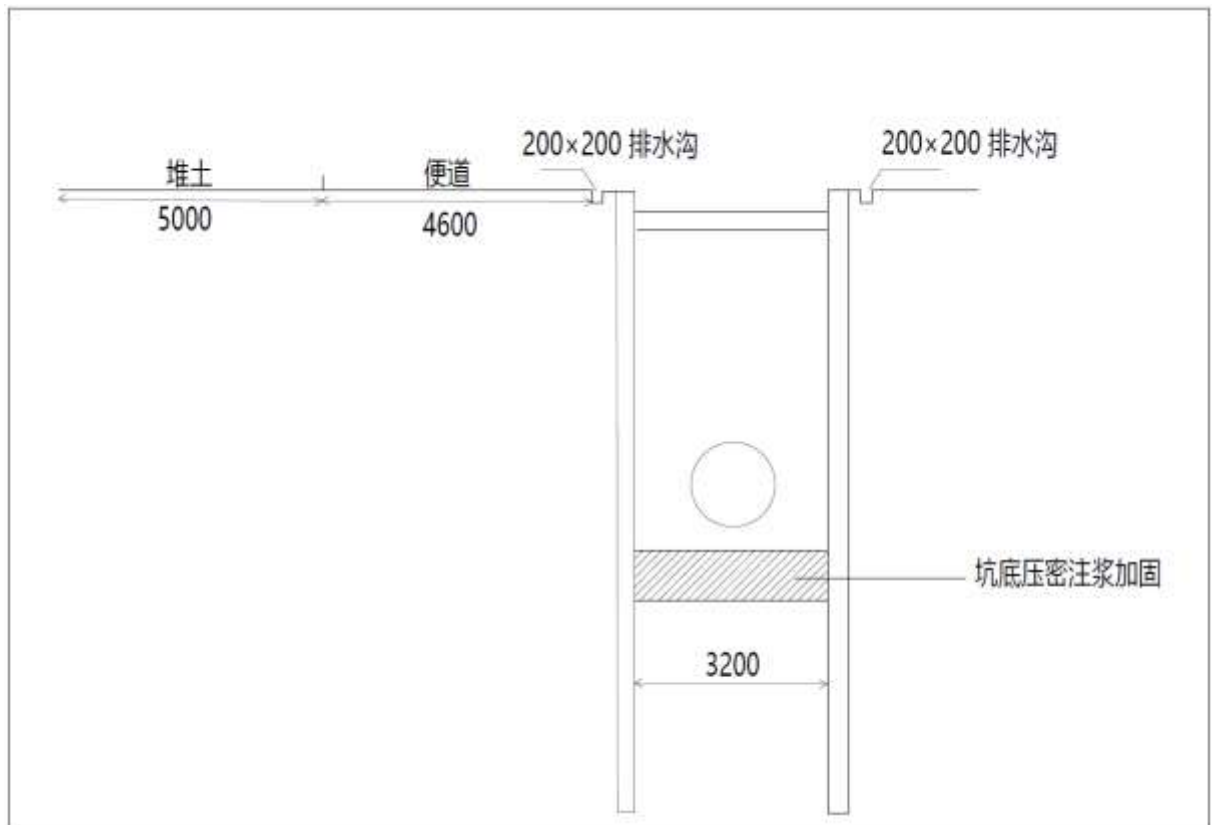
管沟作业带横断面布置示意图 (DN1600)
